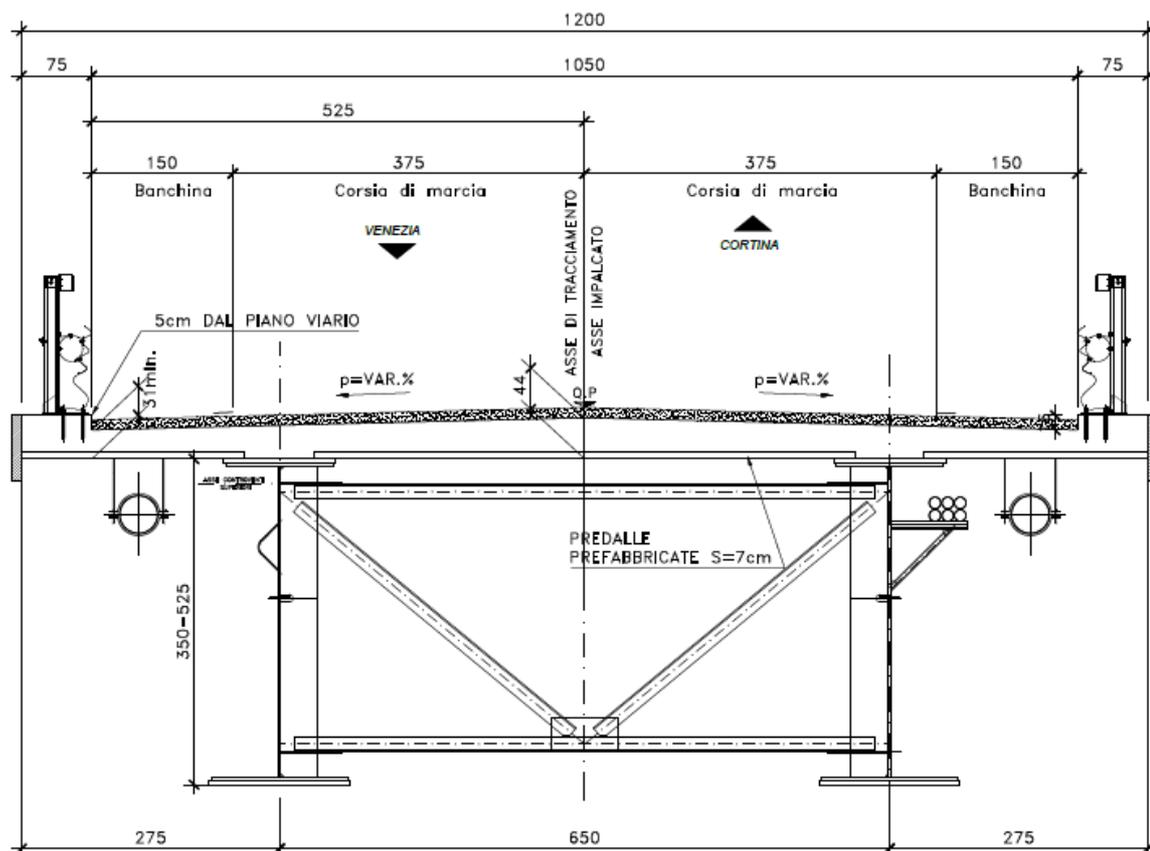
Sezione trasversale impalcato tra pila SPA e pila P4.
